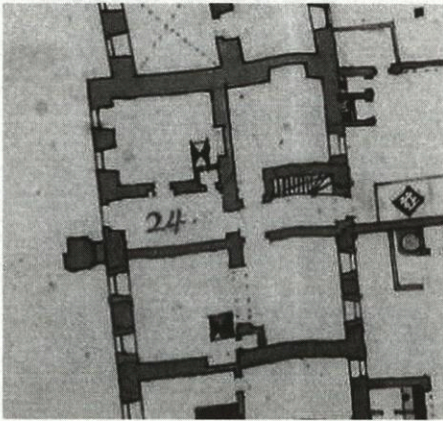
Obermünsterplatz 10, Grundriss vor 1766 (Münchner Plan).
